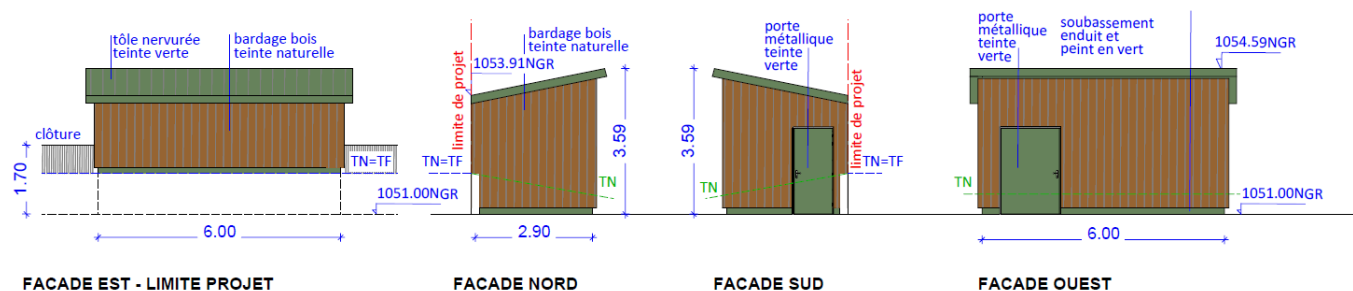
Plan des façades du Poste de Livraison (Pdl)
